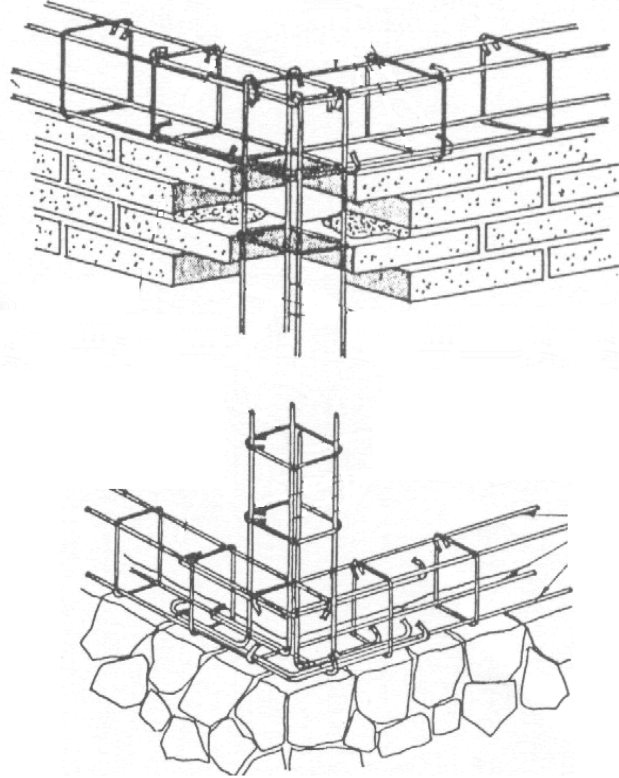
Betonarme hatıllarda donatı detayı örneği (IAEE, 2005)
